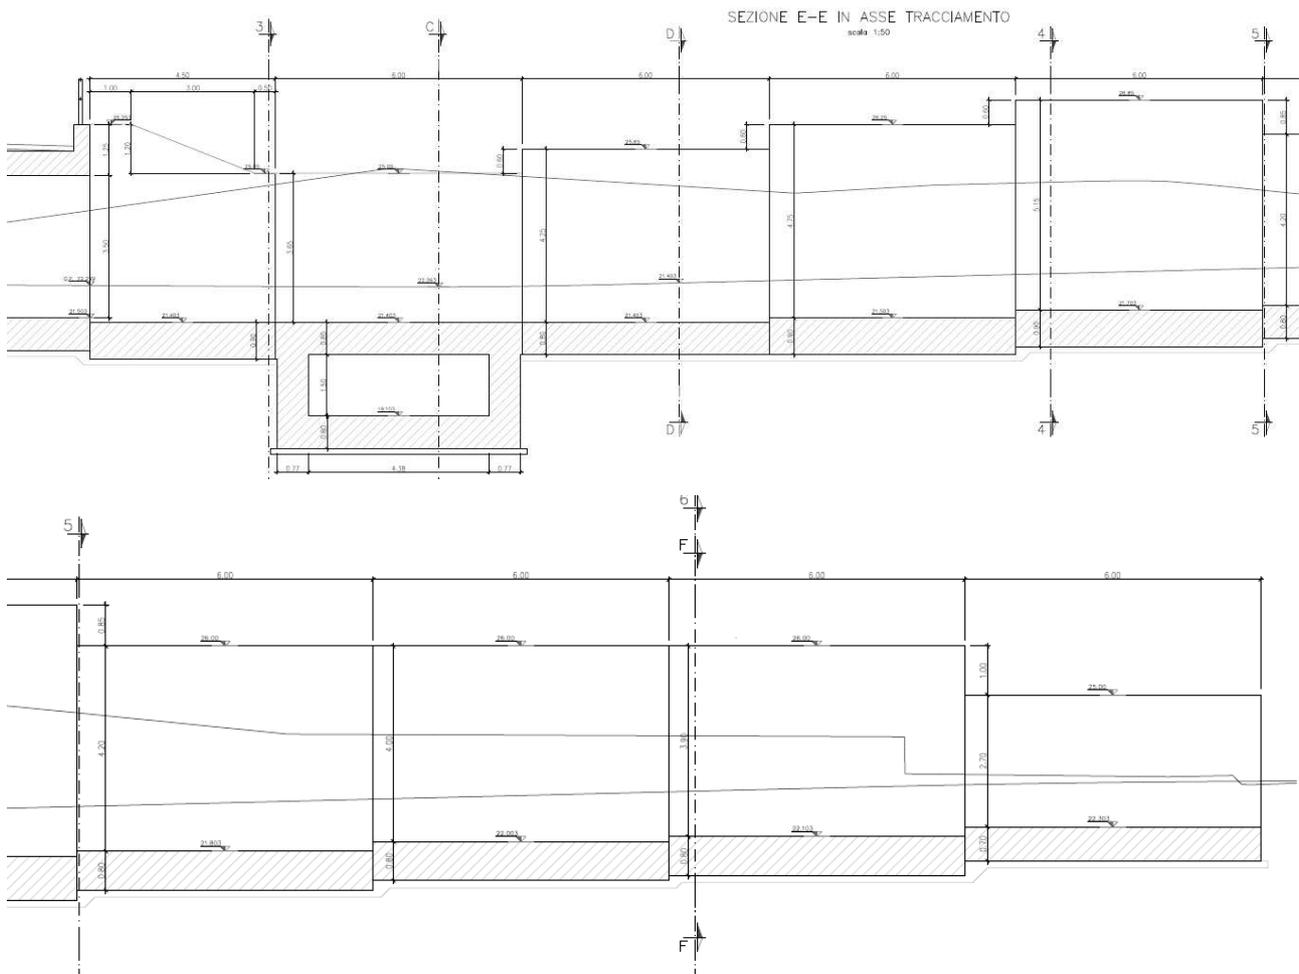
Muri di sbocco/imbocco lato Est - Sezione longitudinale
